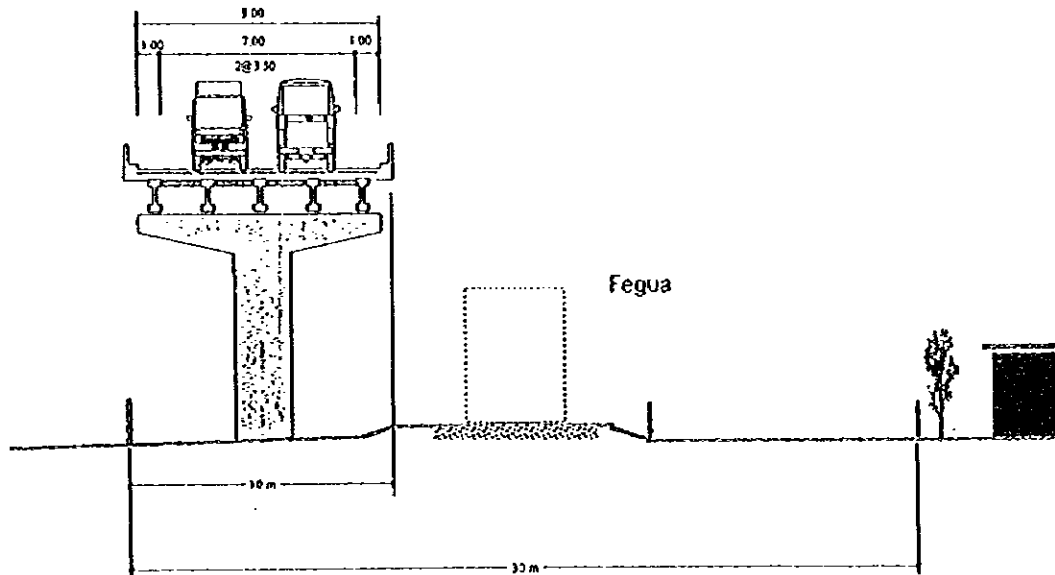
Sección Transversal Typica e Ruta FEGUA - Viaducto
